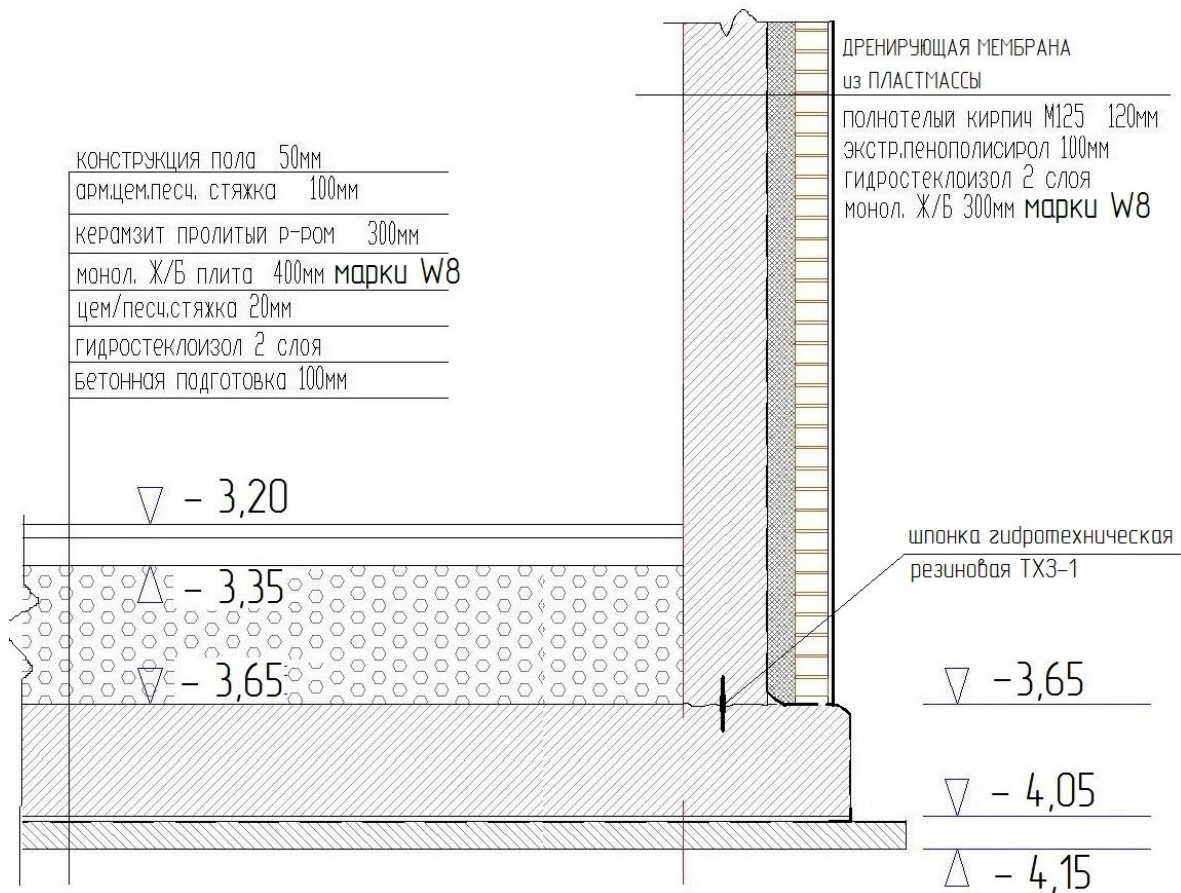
Гидроизоляция фундамента и стен подвала из монолитного железобетона
